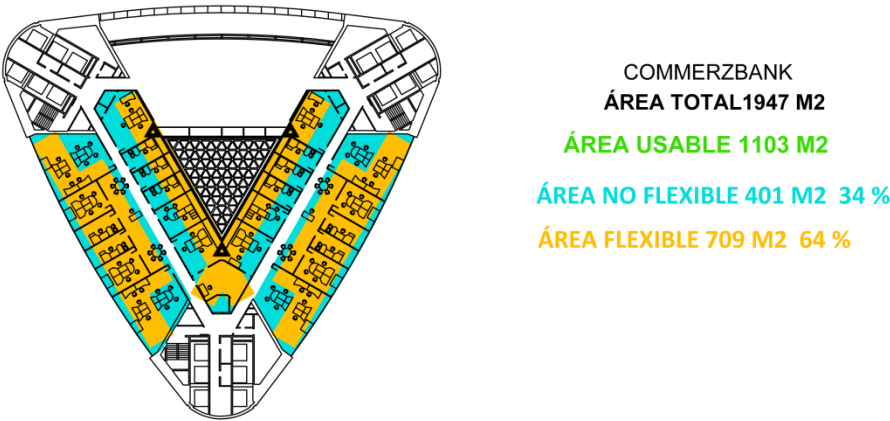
Análisis de Flexibilidad, Planta tipo Commerzbank.
